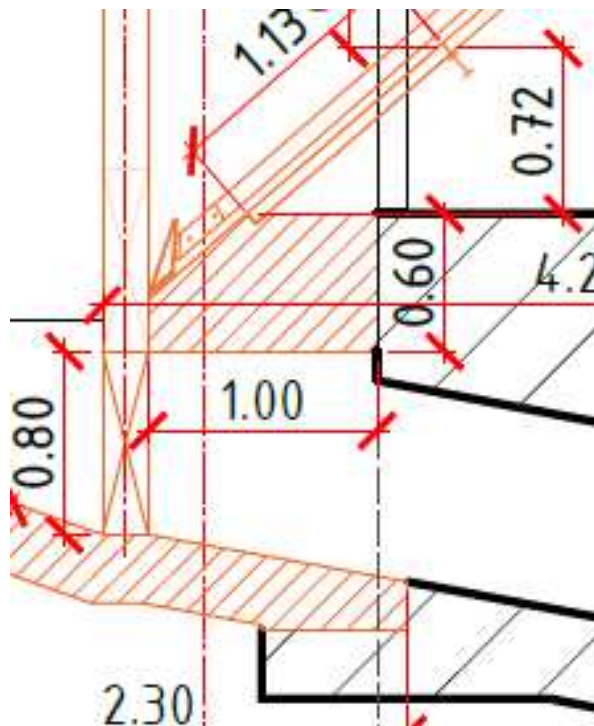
Conditions de calcul de la grille – interfaces GC/Méca
